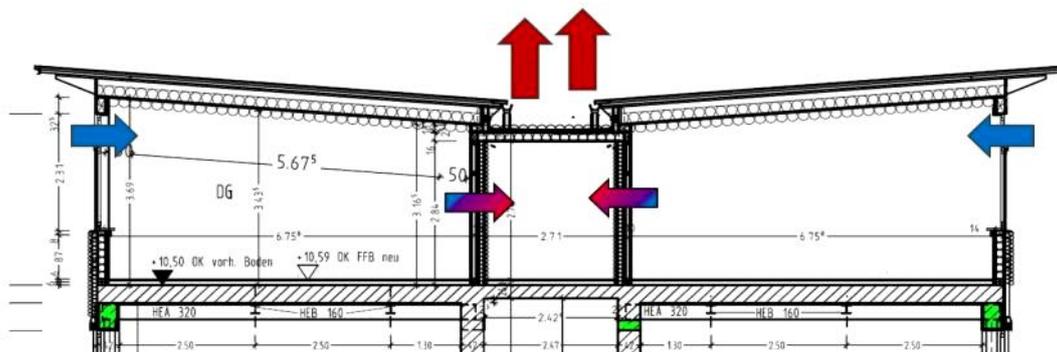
Luftwegeschema im Dachgeschoß der Oststadtschule
